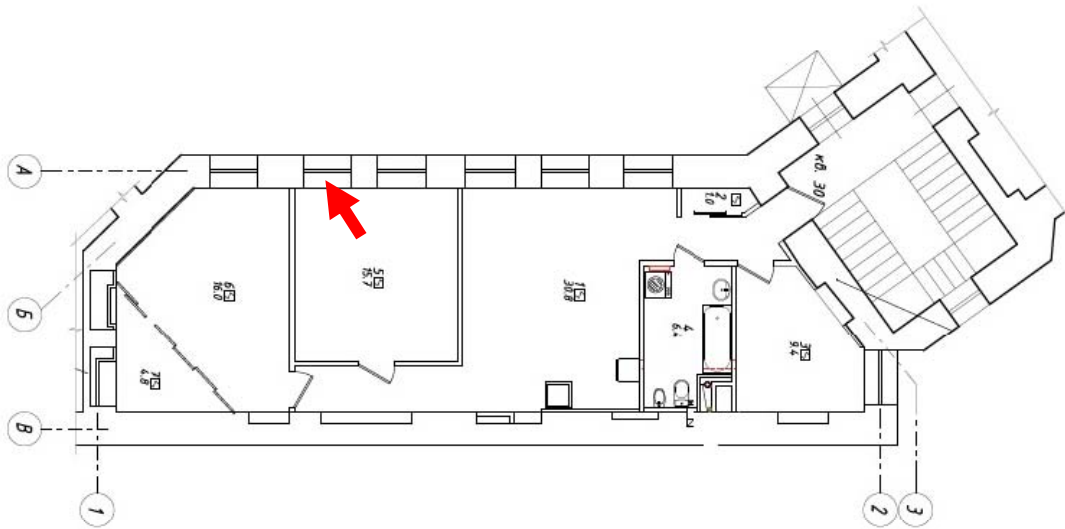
Квартира №30, помещение №5, оконное заполнение.
